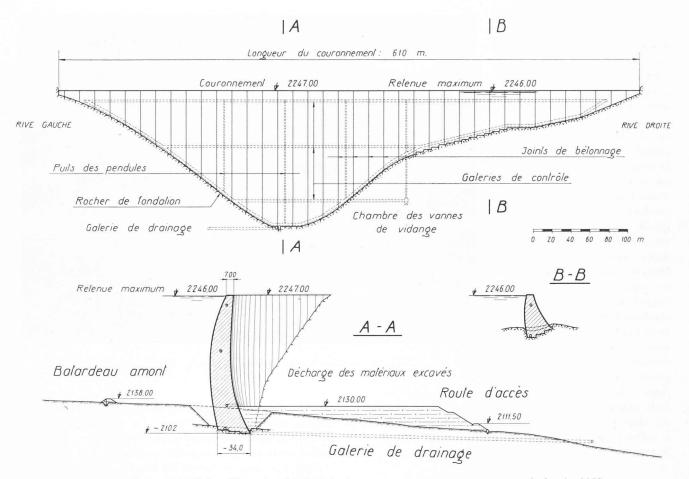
Barrage de Moiry. Elévation développée du parement amont, et coupes verticales 1:4000.
